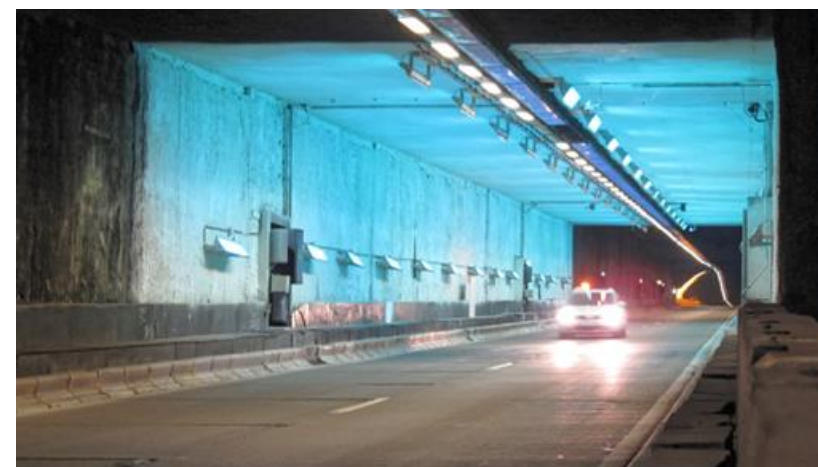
Applicazione di vernice fotocatalitica sulle pareti interne di un tunnel cittadino a Bruxelles
